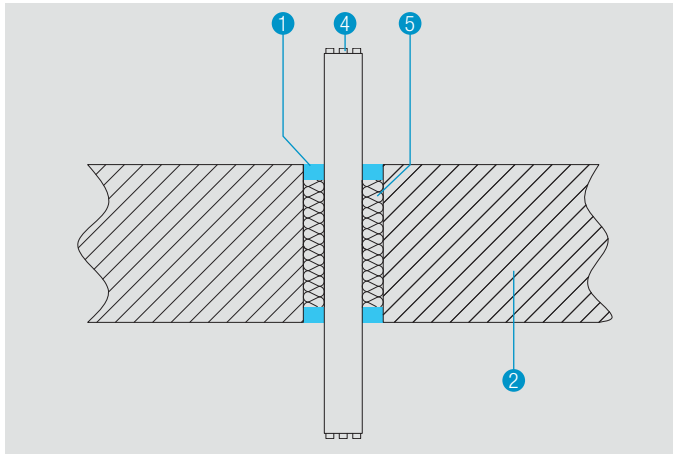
Detail C - Ringspaltverschluss bei Stahlrohr mit nicht brennbarer Isolierung
